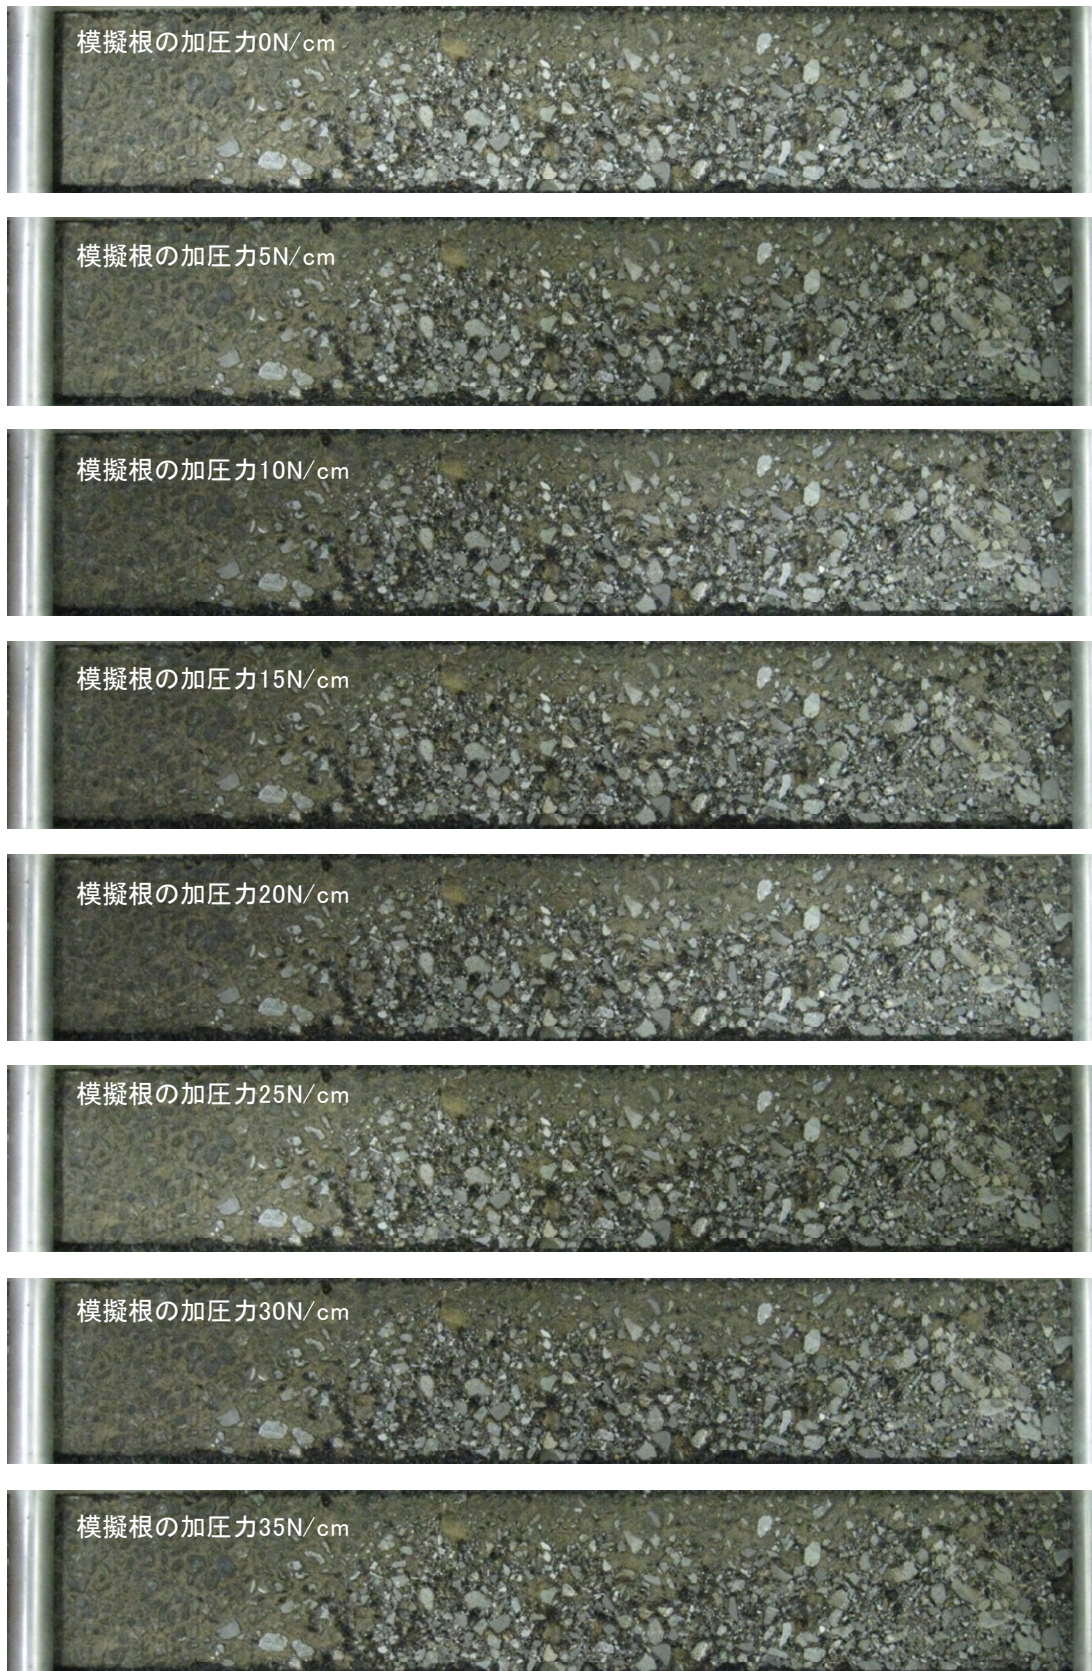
アスファルト舗装表面のひび割れ状態の一例(模擬根直上の砂層の厚さ50mm) 1/3
